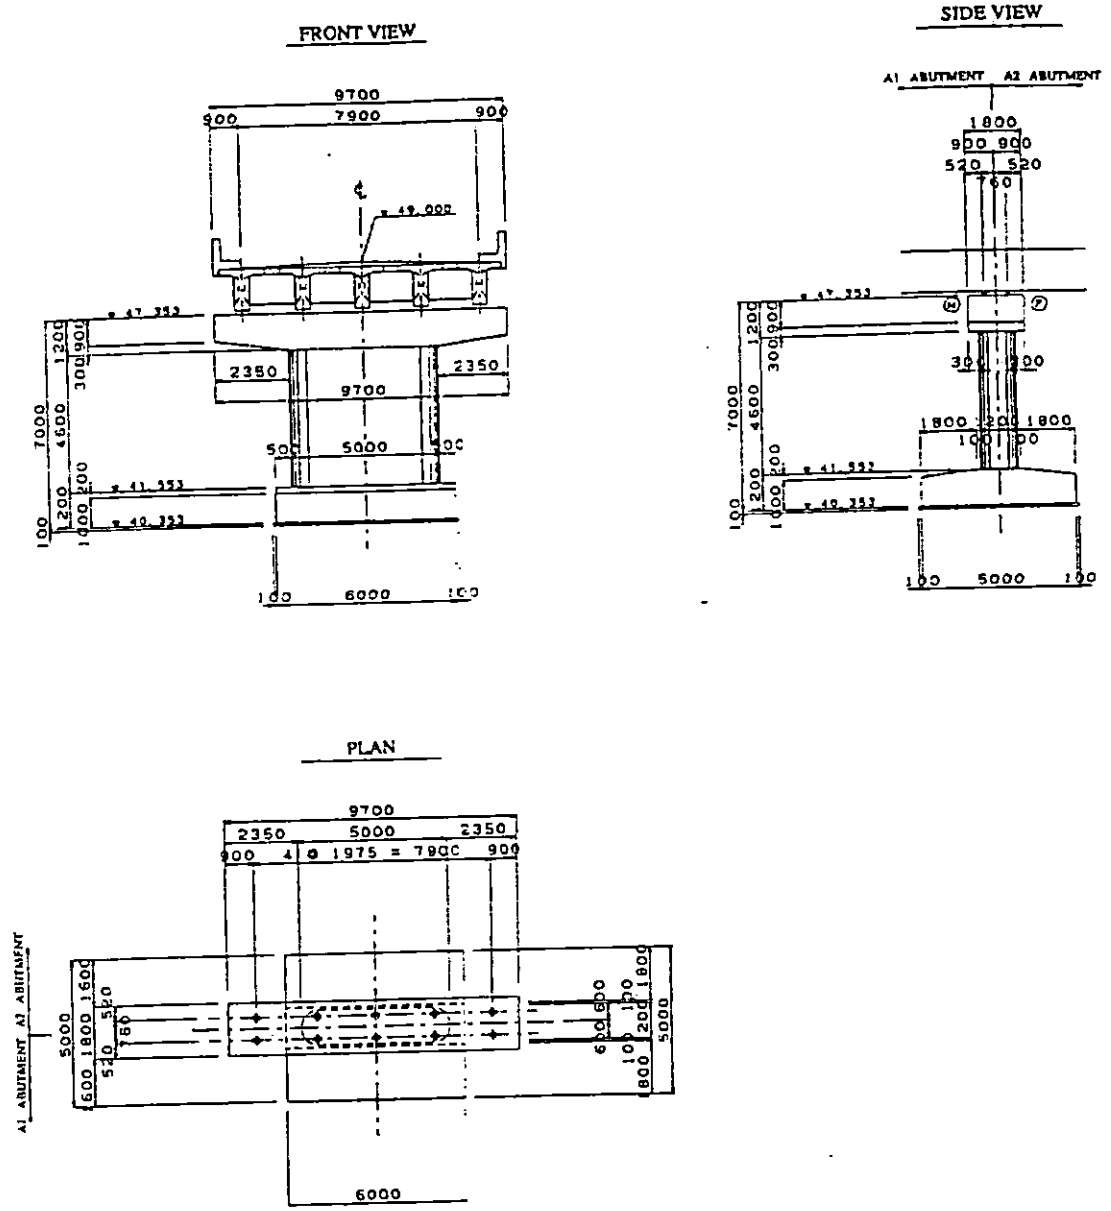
DETALLES DE LA PILA CENTRAL.
